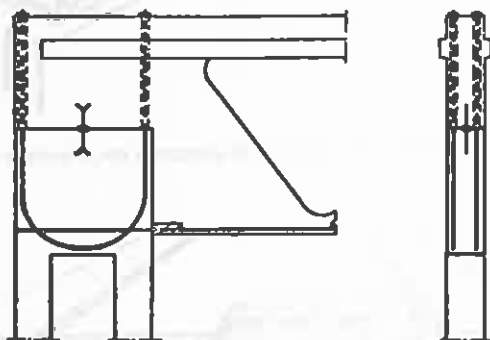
Pormenor de apoio de asna em pilar. Ver também Fig. 38 e 39
